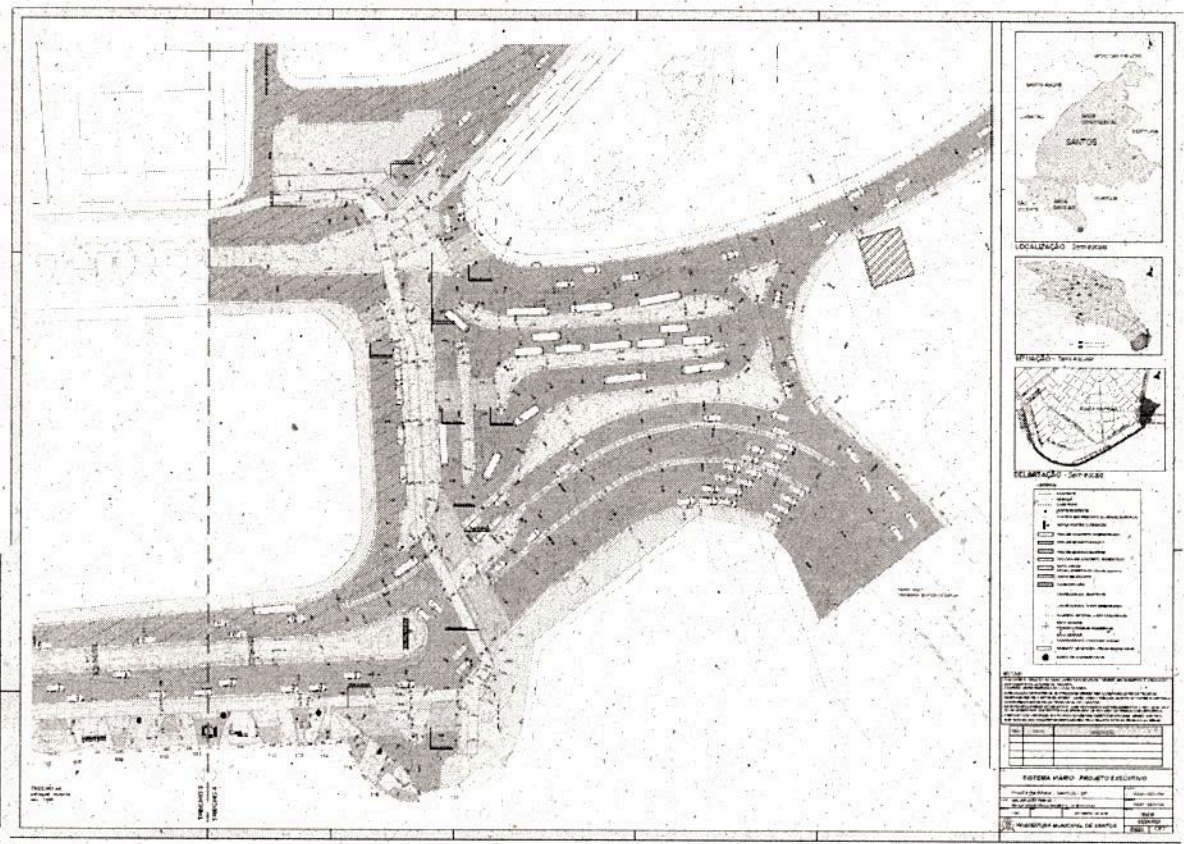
Planta de detalhe do projeto proposto para área em torno do Mercado de Peixes e embarque da balsa
